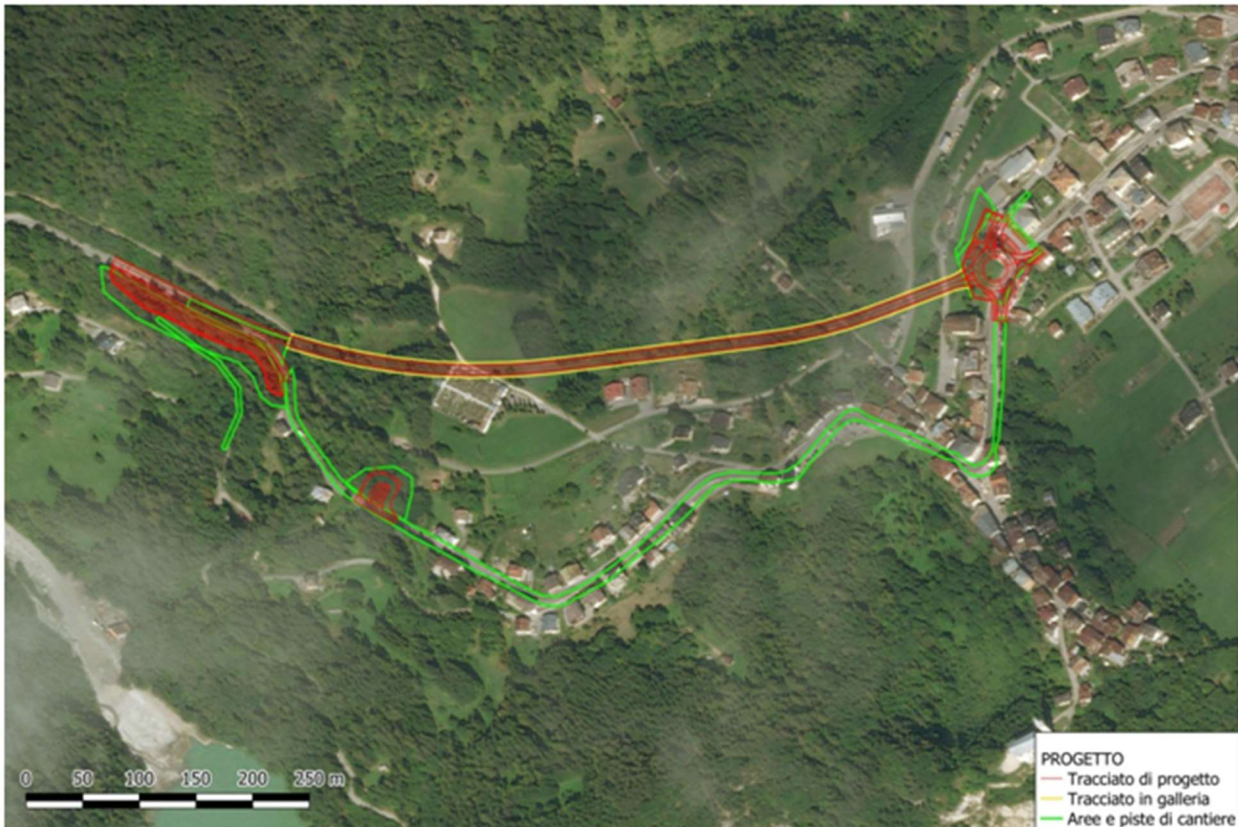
Localizzazione del aree di progetto e delle aree di cantiere su Ortofoto (Base cartografica: Bing satellite 2019)
